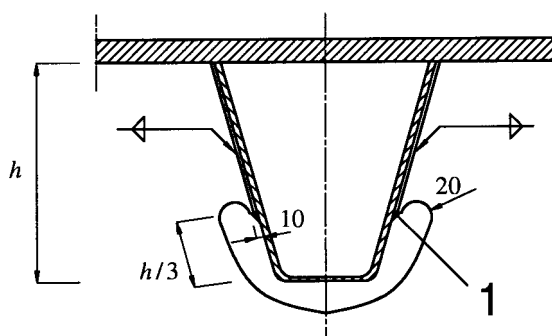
Assemblage entre un raidisseur plat et l'âme d'une poutre transversale
